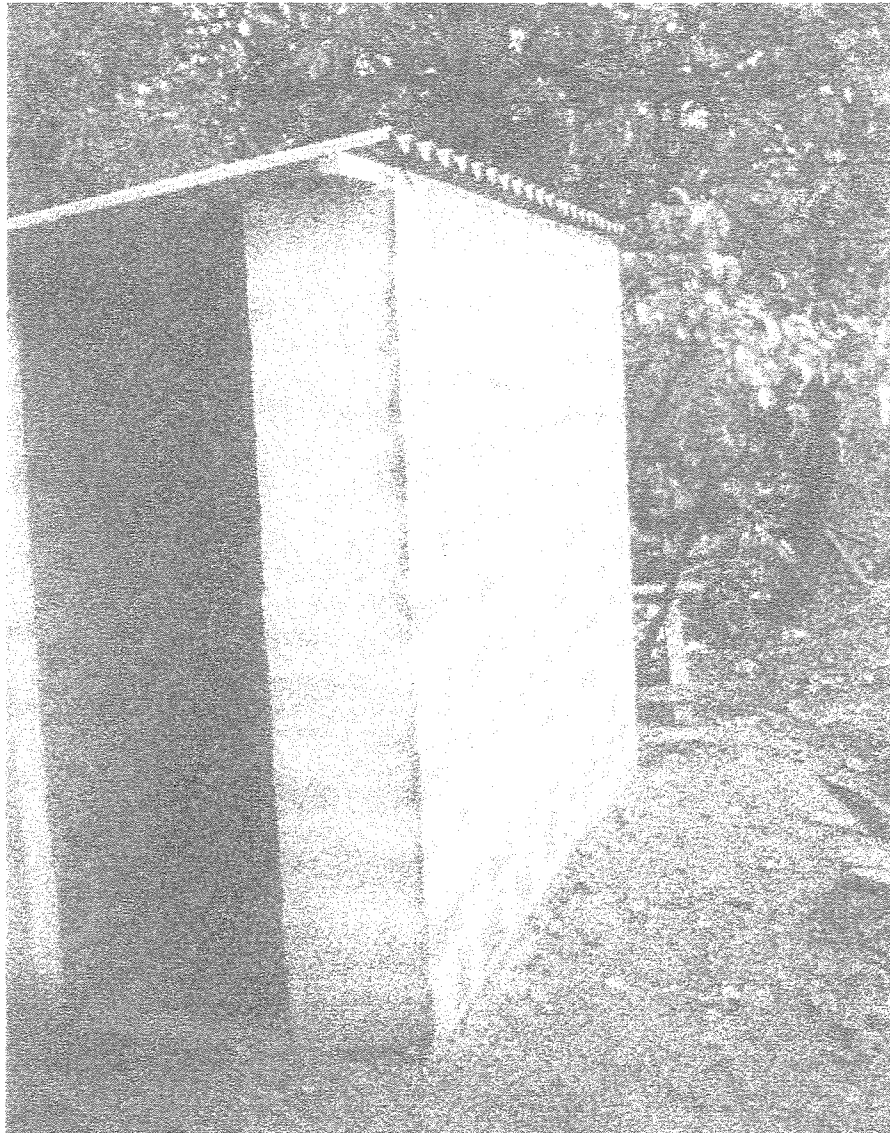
Construção da alvenaria em bloco de concreto, e cobertura com telhas de fibrocimento, para aplicação das diversas misturas.
